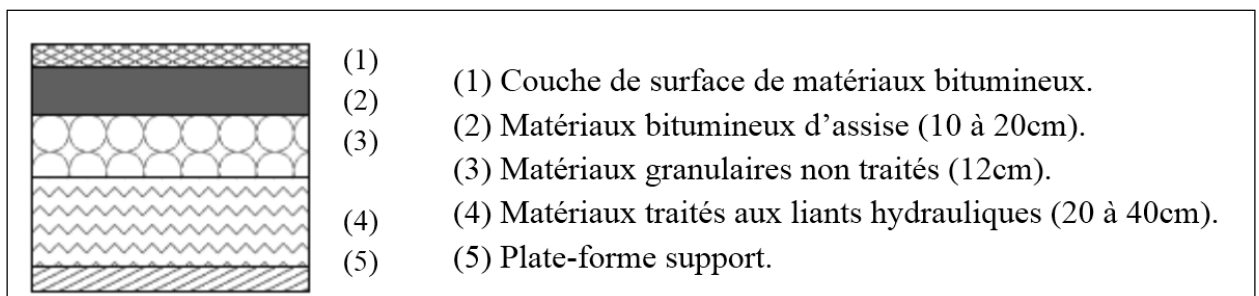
Structure d'une chaussée à structure inverse (MEZIANI, 2008)
